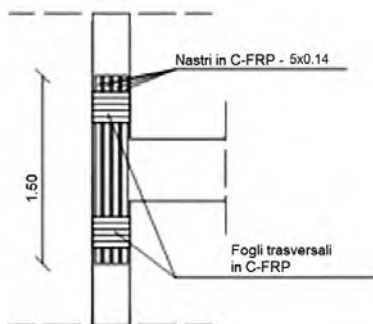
Pilastri interessati dall'intervento con C-FRP
